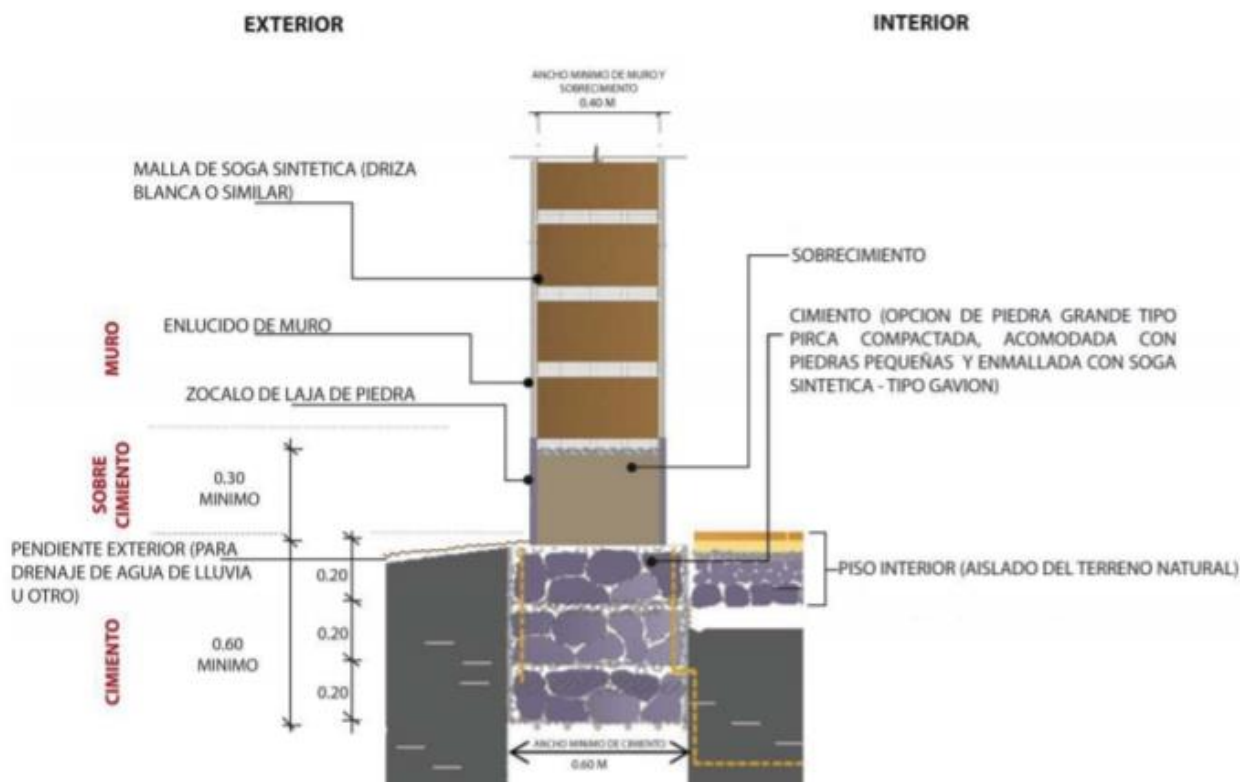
(MINISTERIO DE VIVIENDA, 2017, pág. 13)
